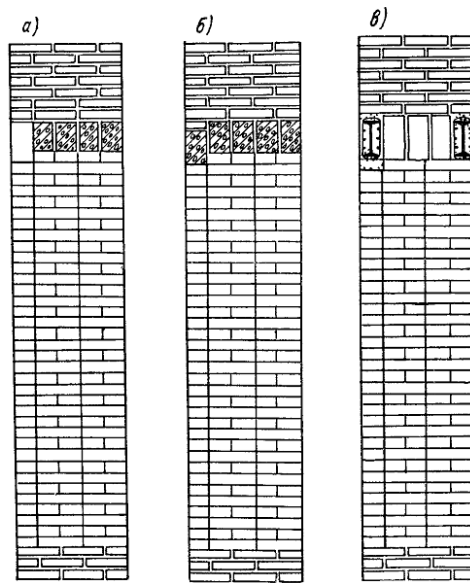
Замена кирпичных перемычек сборными железобетонными с сохранением облицовочного ряда кладки (а); сборными железобетонными на всю толщину стены (б), металлическими (в)
